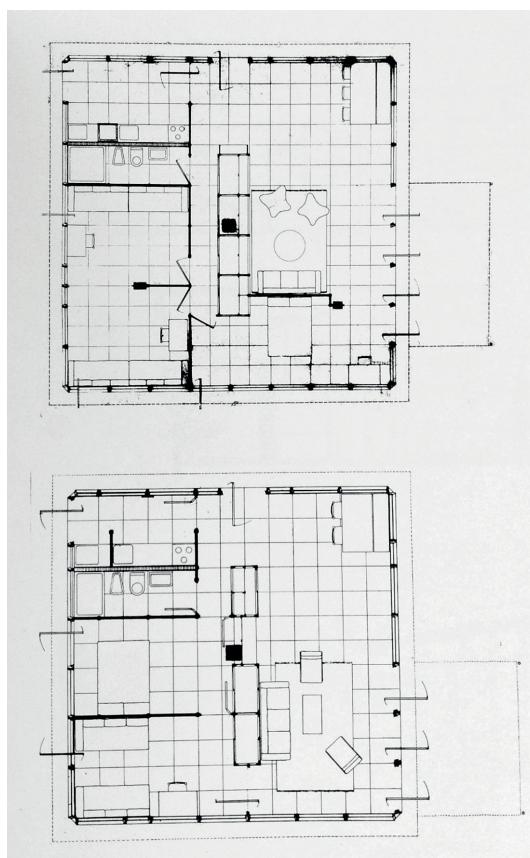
Sistema BGB. 1949. Plantas tipo A y tipo B.
